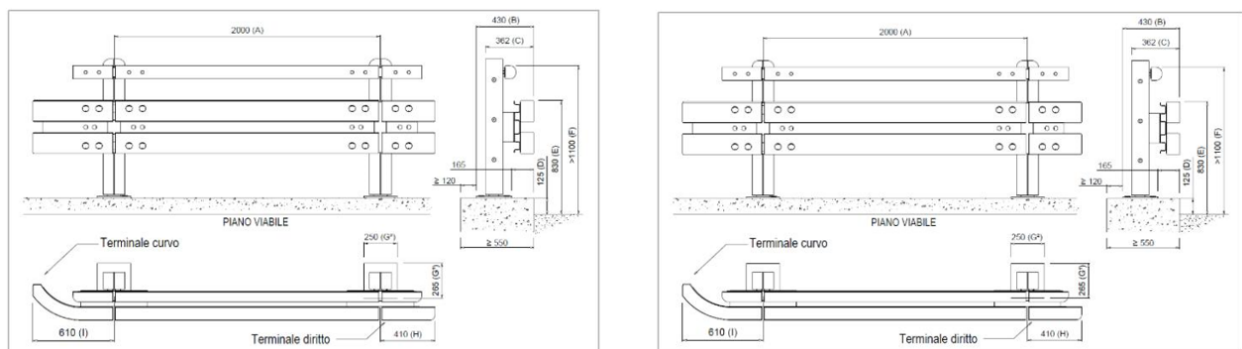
Pianta, prospettiva e sezione tipo della barriera H1 BL e H2 BP in legno e Corten
